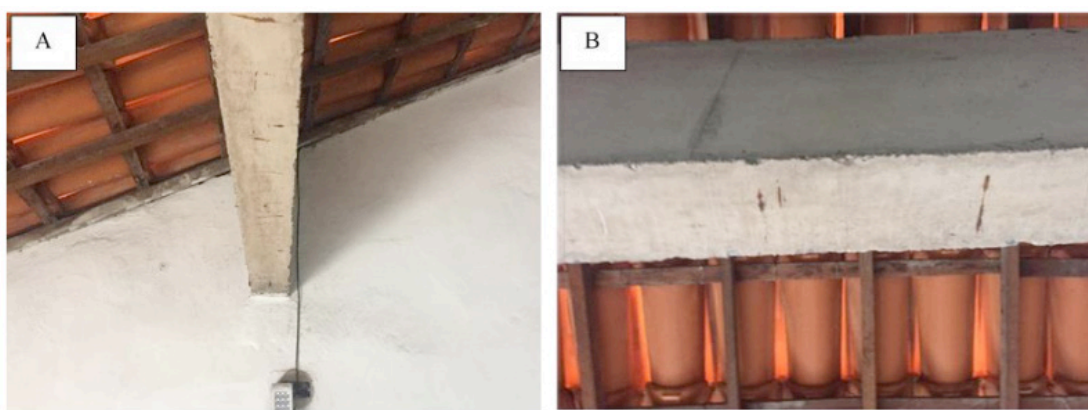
(A) e (B) Vigas transversais da estrutura de apoio da cobertura com armaduras expostas com corrosão incipiente.
